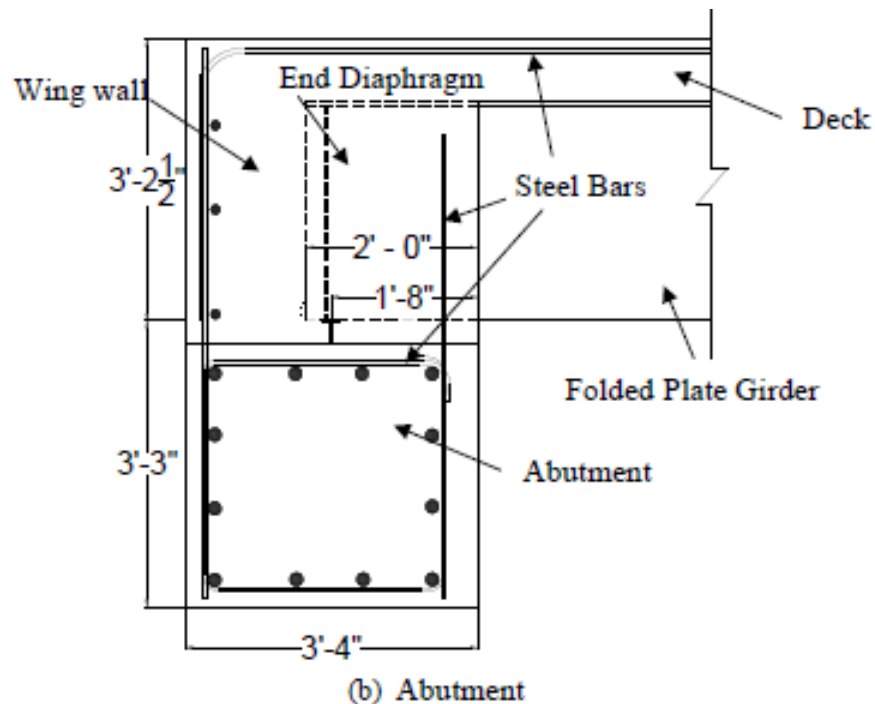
Sistema de apoyo, se muestra viga de chapa metálica plegada y diafragma extremo embebido en viga transversal de apoyo, de Evaluation of a Folded Plate Girder Bridge System Final Report June 2017
